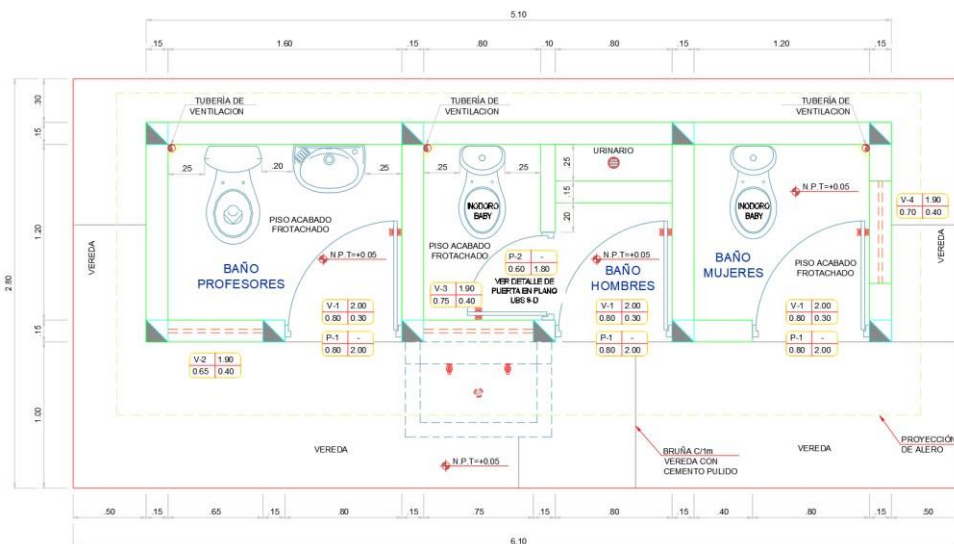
Propuesta de Plano planta de la UBS en la I.E.
